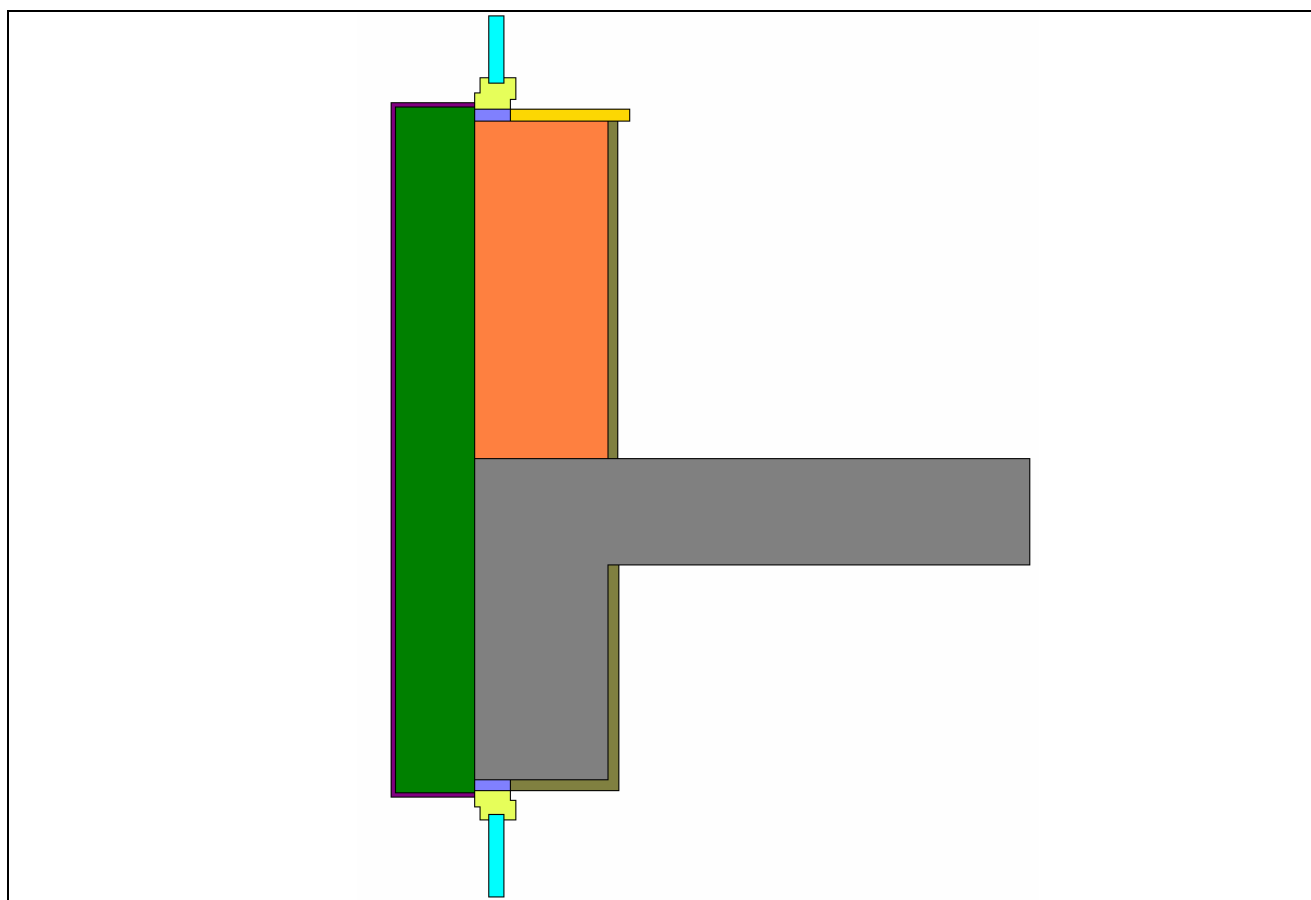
Схематическое изображение вертикального разреза стены с теплоизоляционным фасадом в зоне расположения светопроемов с оконными блоками.
